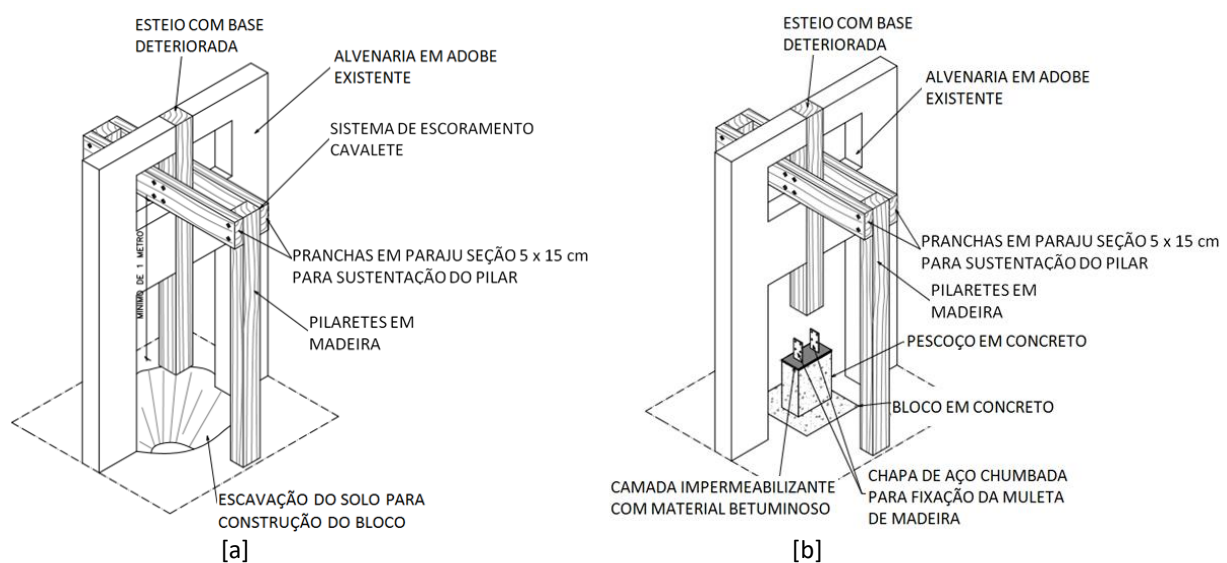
[a] Escavação para o bloco de fundação; [b] Concretagem do bloco e pescoço.
